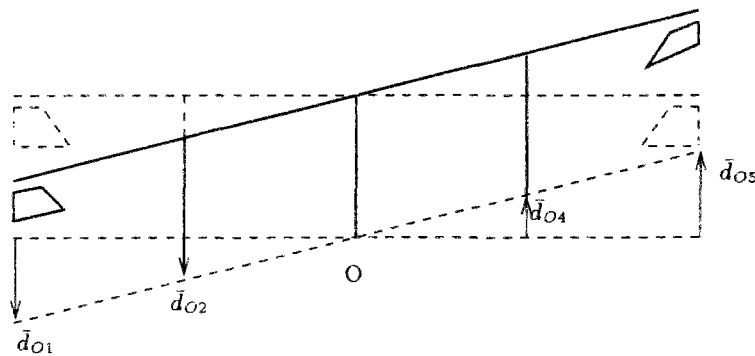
Effet statique sur la structure d'une rotation du sol de fondation
